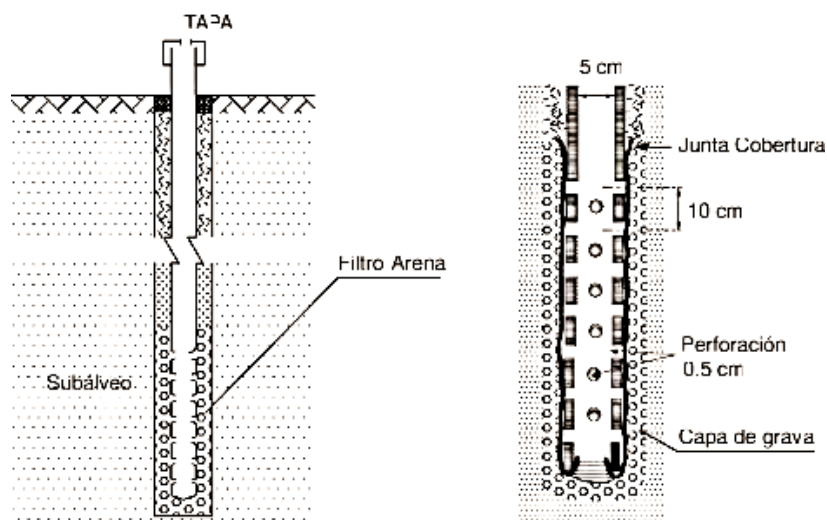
Montaje de piezómetros. Galerías filtrantes
